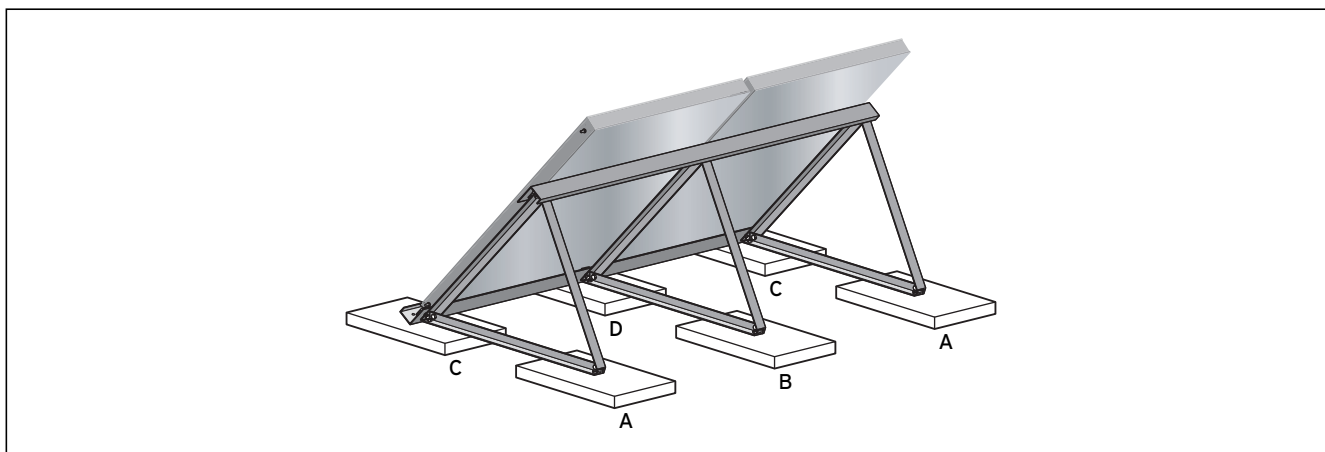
Fijación en el suelo con bloques de hormigón
